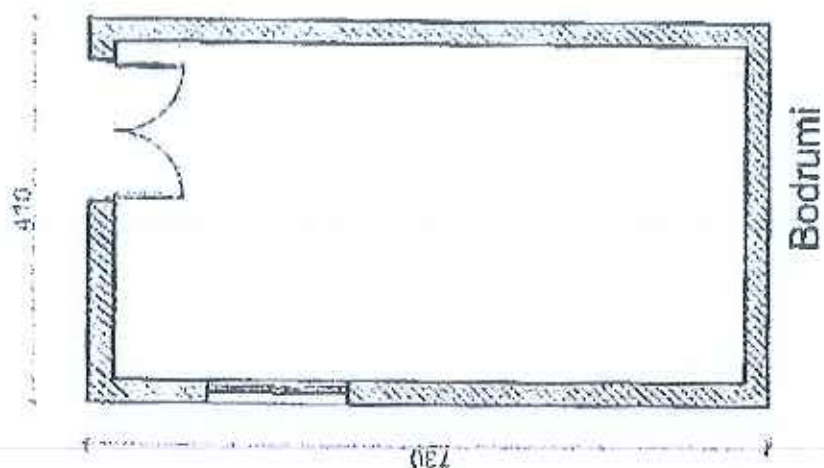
Planimetria e bodrumit të objektit me etazhitet B+P – bashkangjitur në Formularin e Inqizimit të Strukturës
